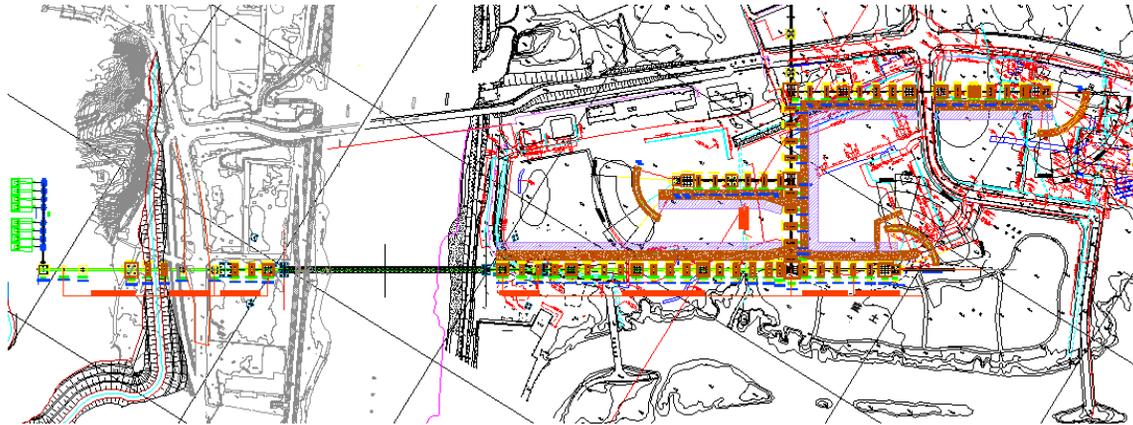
巨大ベルトコンベアの設置計画（平面図）
